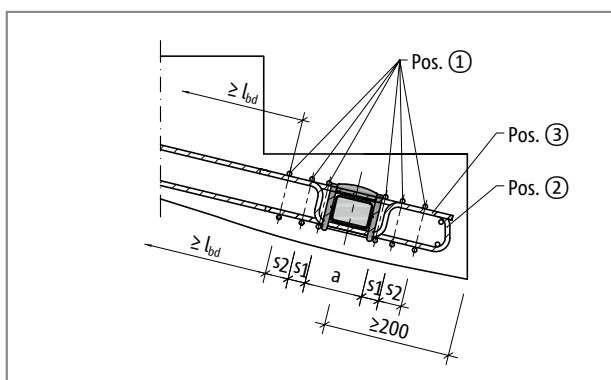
Schöck Tronsole® tipo Q, sezione "punto piede"
